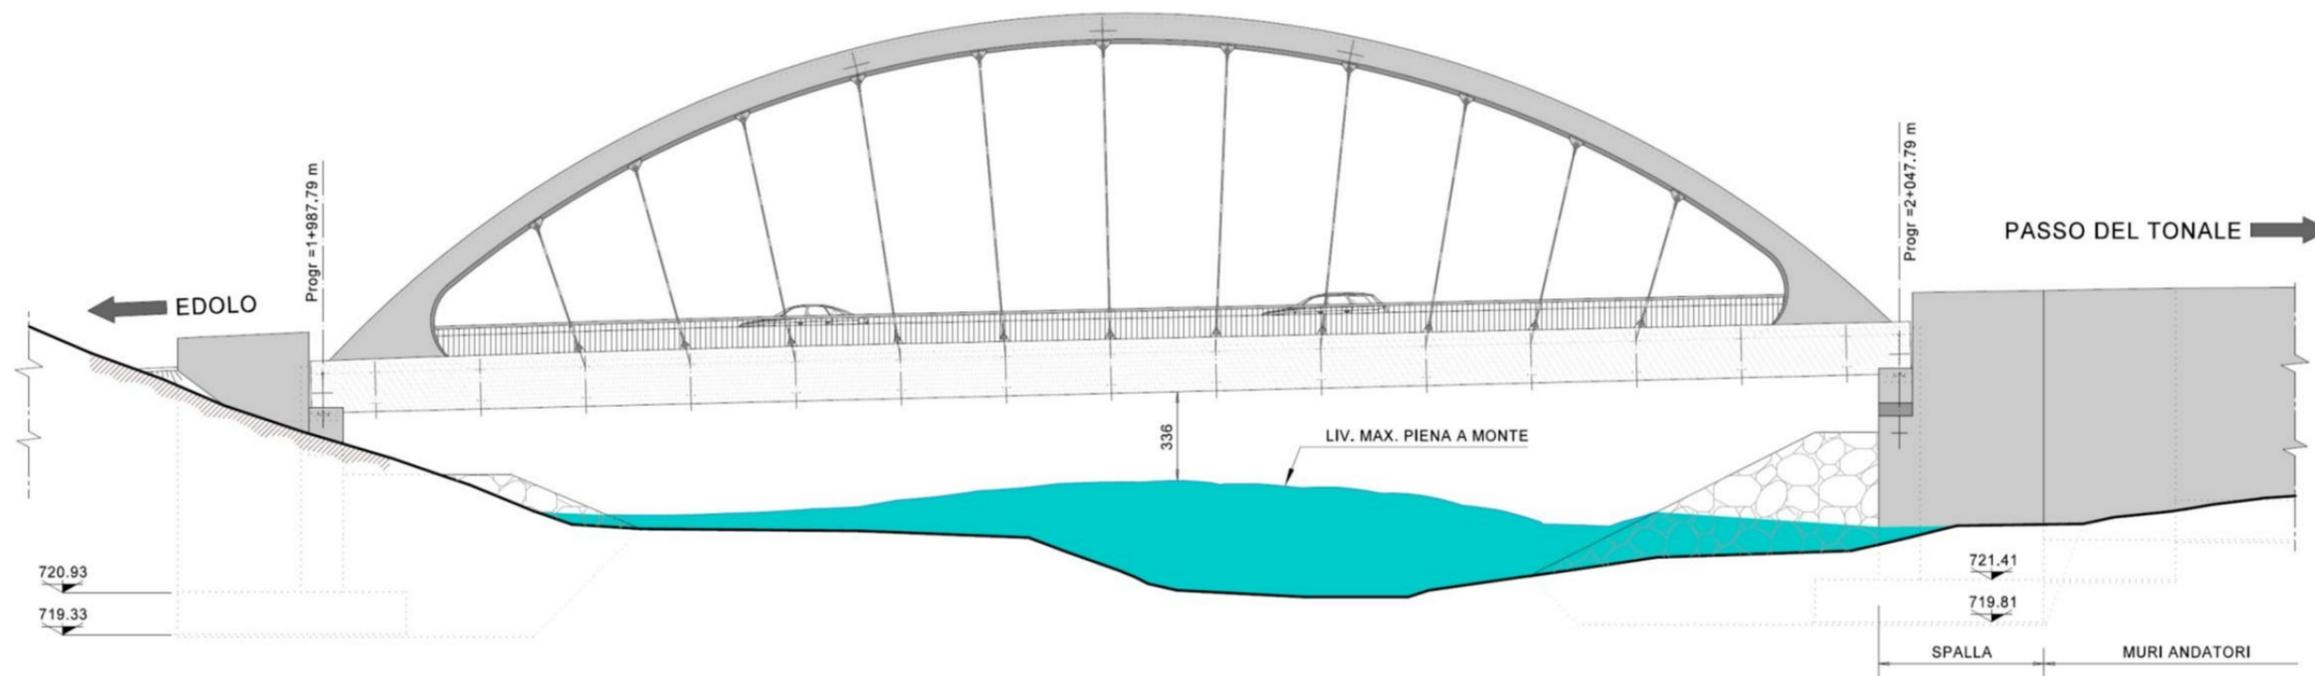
Ponte sul Fiume Oglio – Prospetto Ovest
